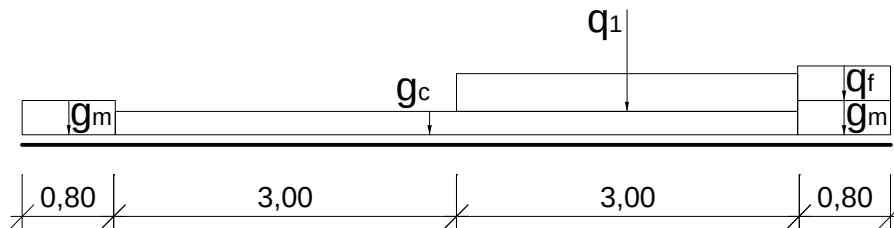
1^a condizione: carichi sulla sezione trasversale dell'impalcato
